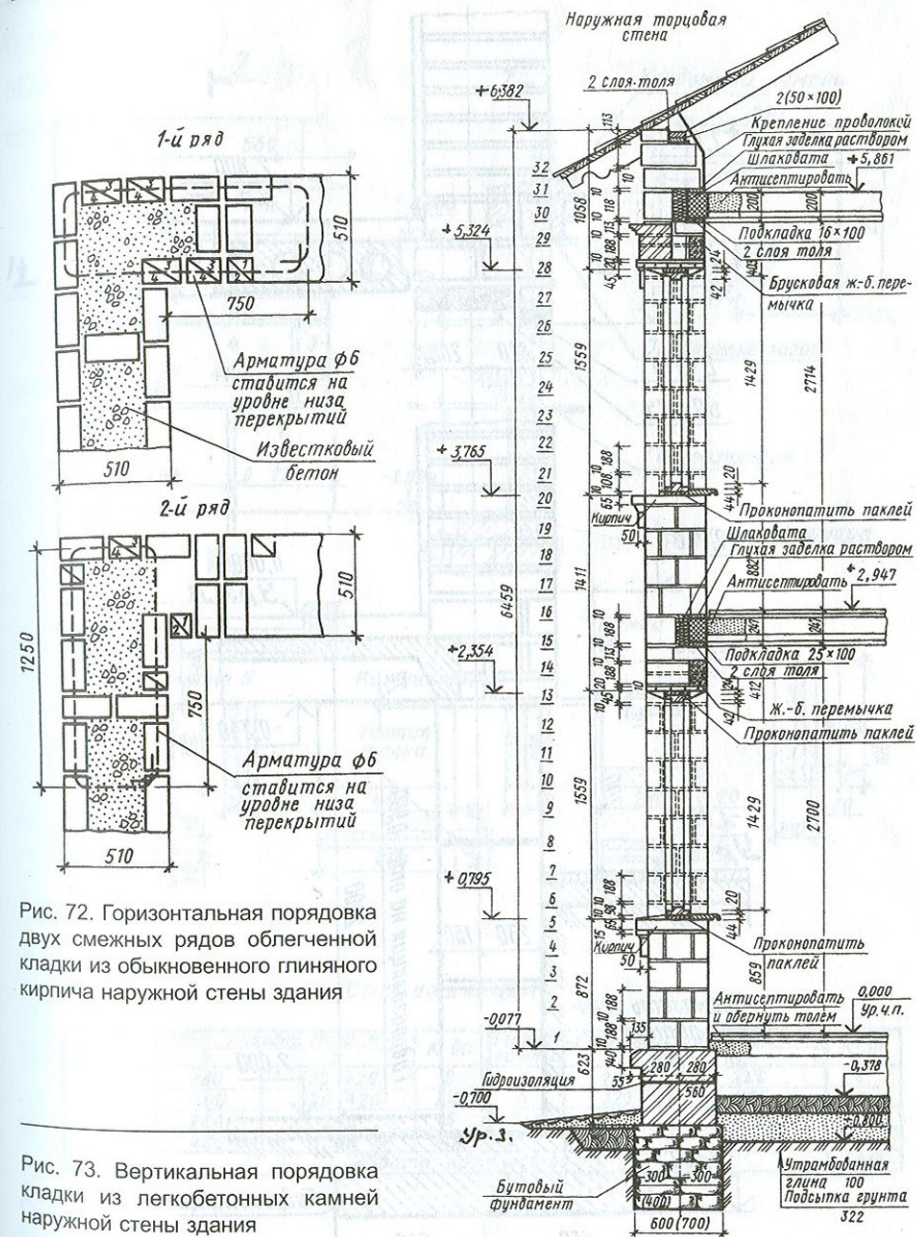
Горизонтальная порядовка двух смежных рядов облегченной кладки из обыкновенного глиняного кирпича наружной стены здания
